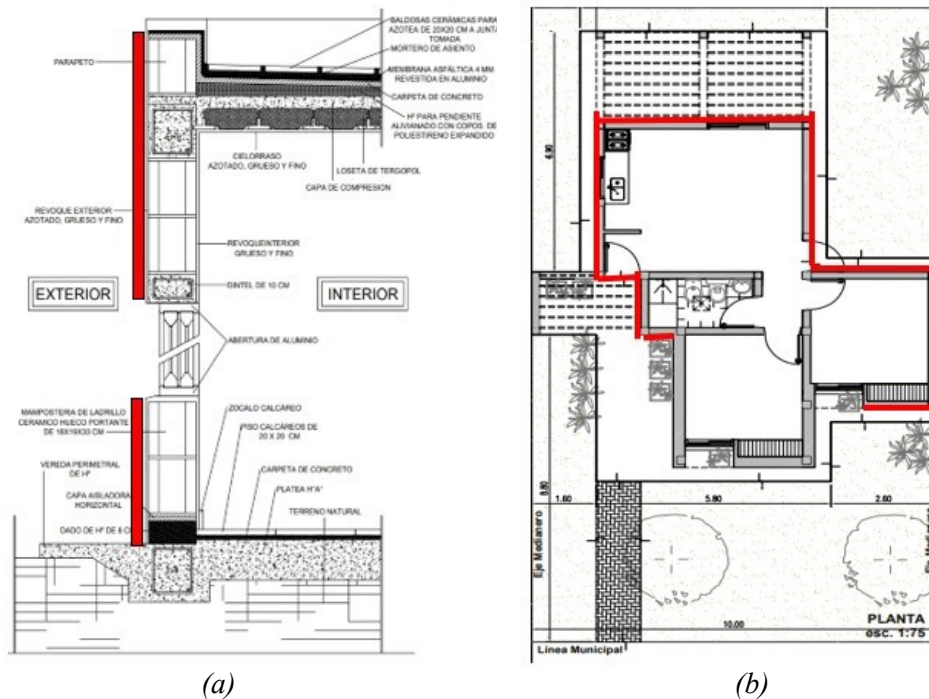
Rehabilitación de la envolvente en muro 2, (a) en corte, (b) en planta
